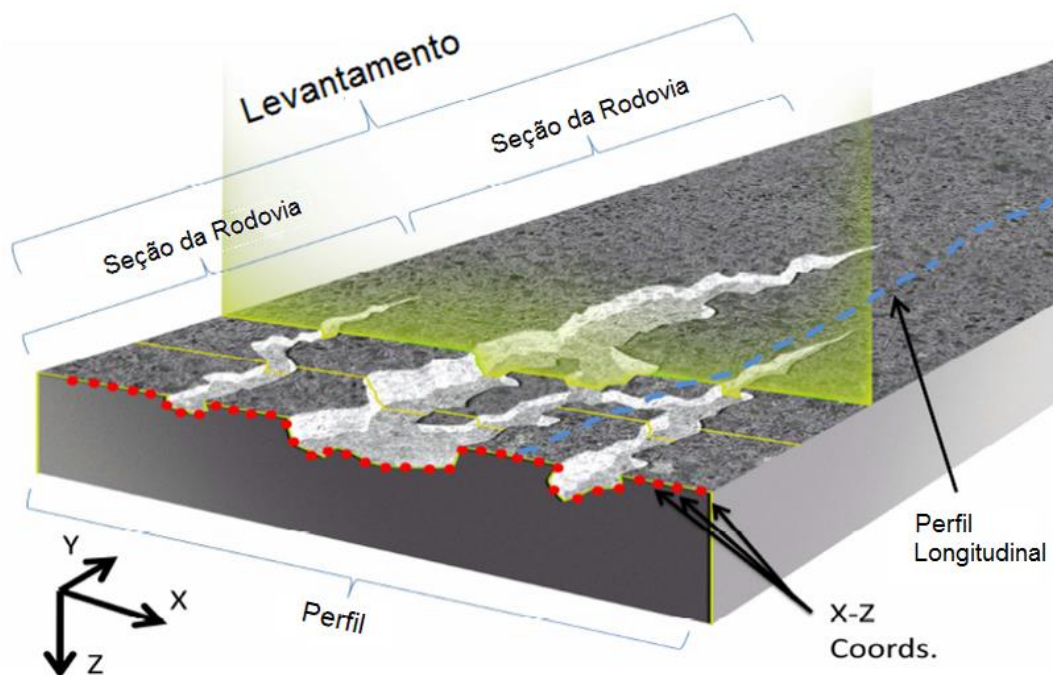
Caracterização do perfil transversal, longitudinal e seção de rodovia.
